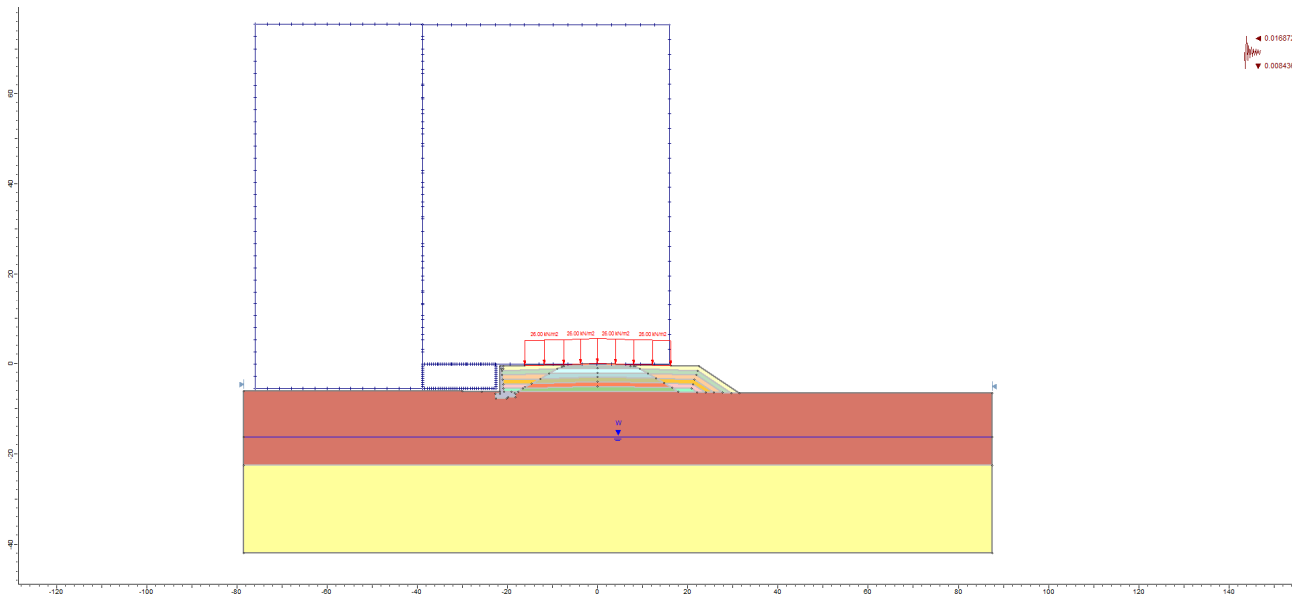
Verifica di stabilità pk 6+736.05. Stabilità lato muro di sostegno. Modello
